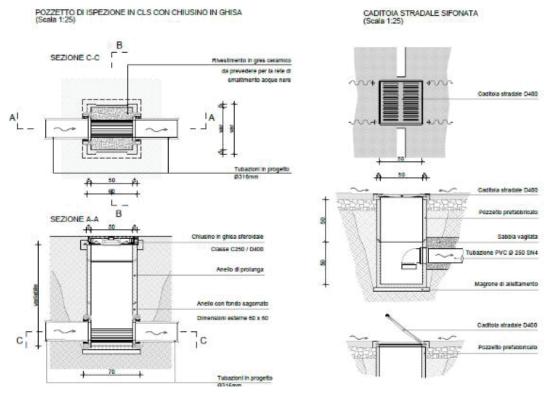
pianta e sezione schematica del pozzetto di ispezione e caditoia (opera tipo)
